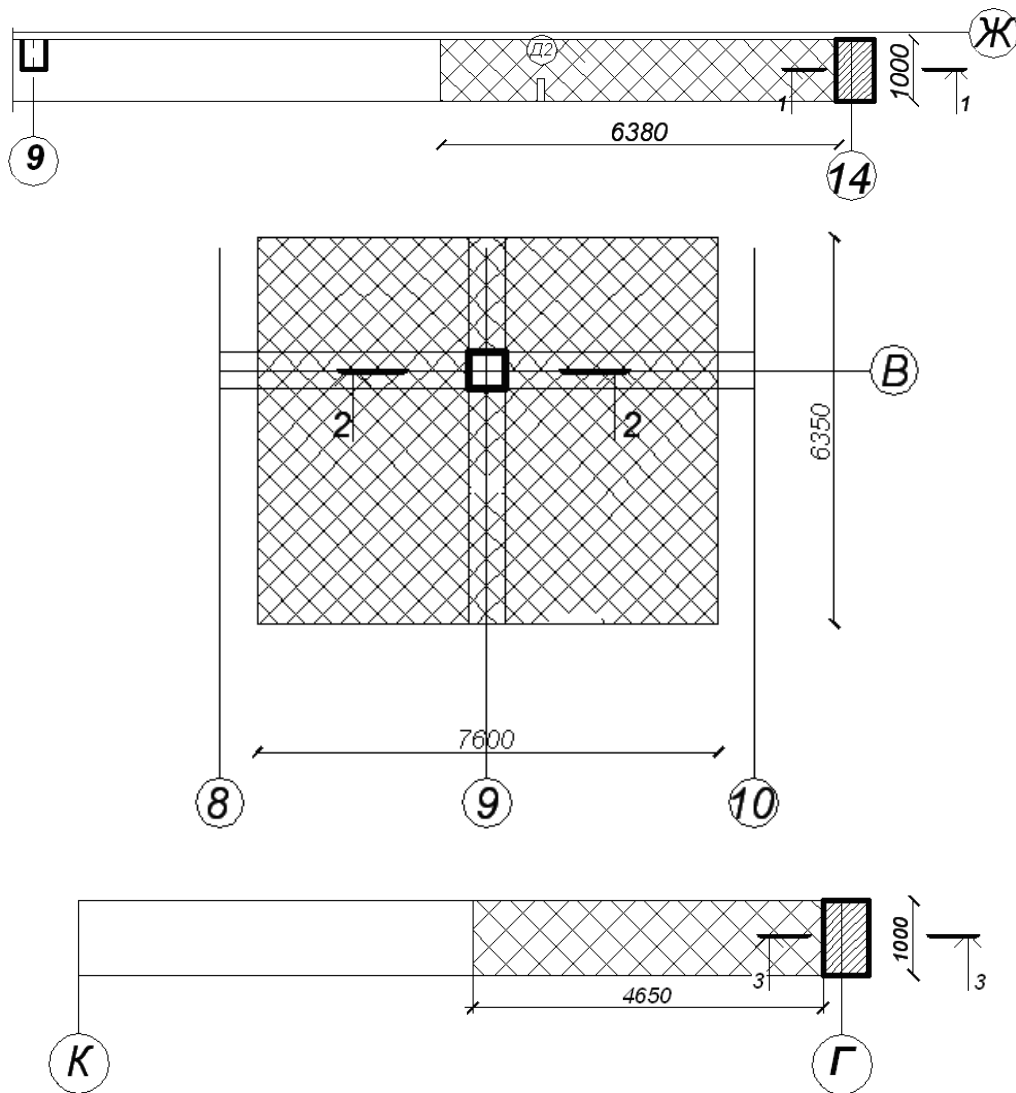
Площа розподілу навантажень на фундамент
